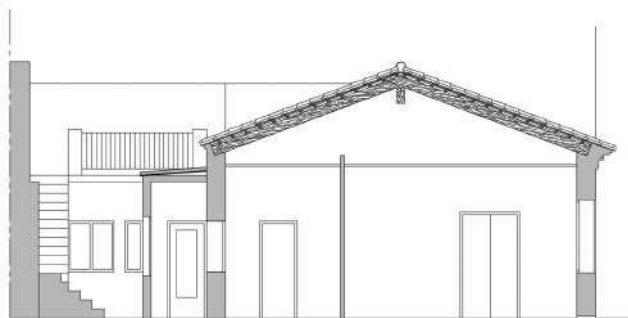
Sección de la vivienda por las escaleras del patio exterior. Fuente propia
